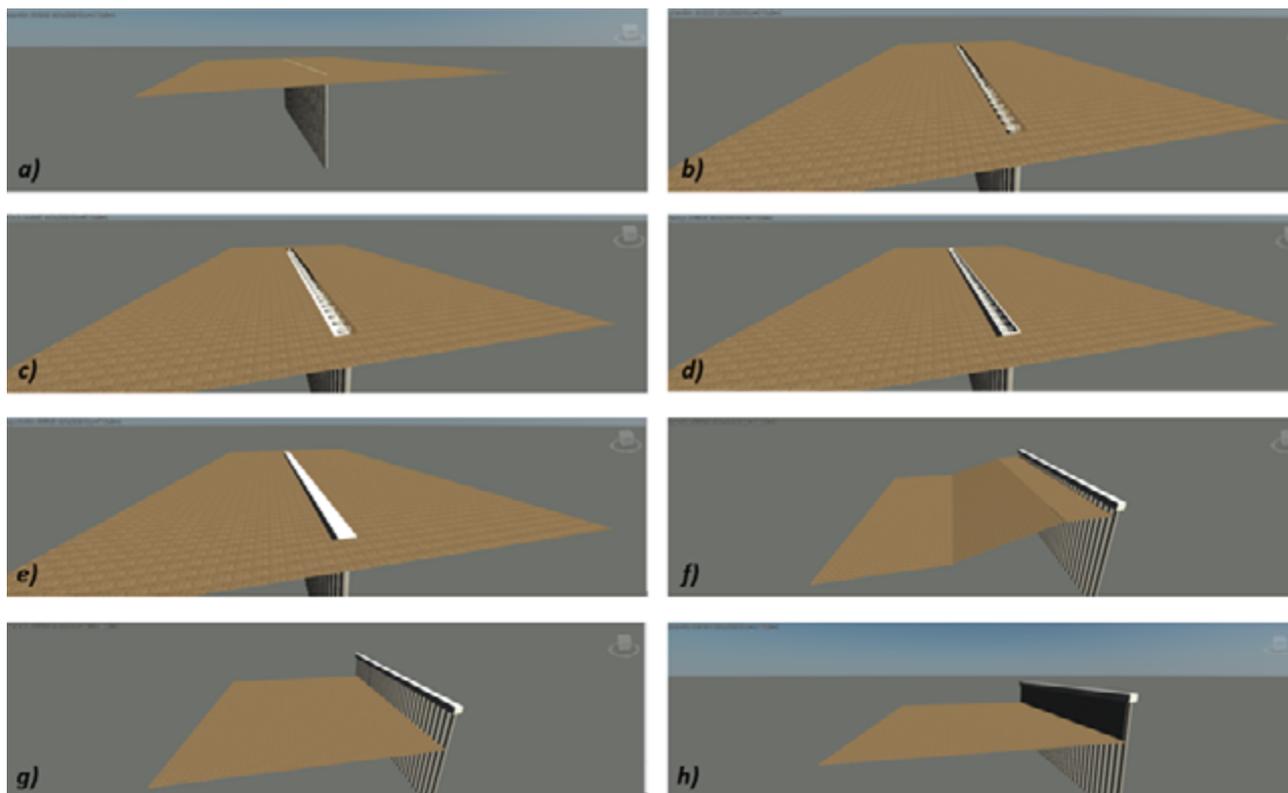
Simulação 4D no software AutoDesk Navisworks do detalhe construtivo da ligação da estaca da contenção com a viga de coroamento. a) Execução das estacas; b) Escavação para execução das vigas de coroamento; c) Concreto magro; d) Formas da viga de coroamento; e) Concretagem da viga de coroamento; f) Escavação do terreno deixando a bermas de equilíbrio, enquanto executa a fundação; g) Após a execução da fundação e travamento com a laje (vide projeto estrutural), retirada da bermas; h) Fechamento da contenção com malha de aço e concreto projetado.
